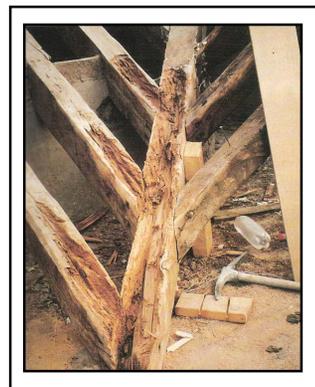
Además de poder ser usada n restauración y rehabilitación, la técnica BETA puede ser utilizada en las construcciones de madera de nueva planta, evitando de esta manera, el empleo de elementos metálicos
